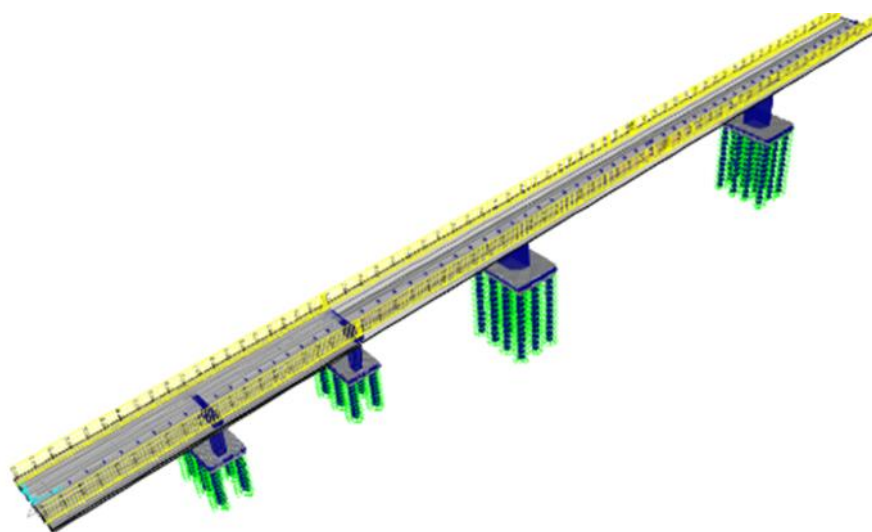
Carga de barrera tipo New Jersey puente San Pedro
